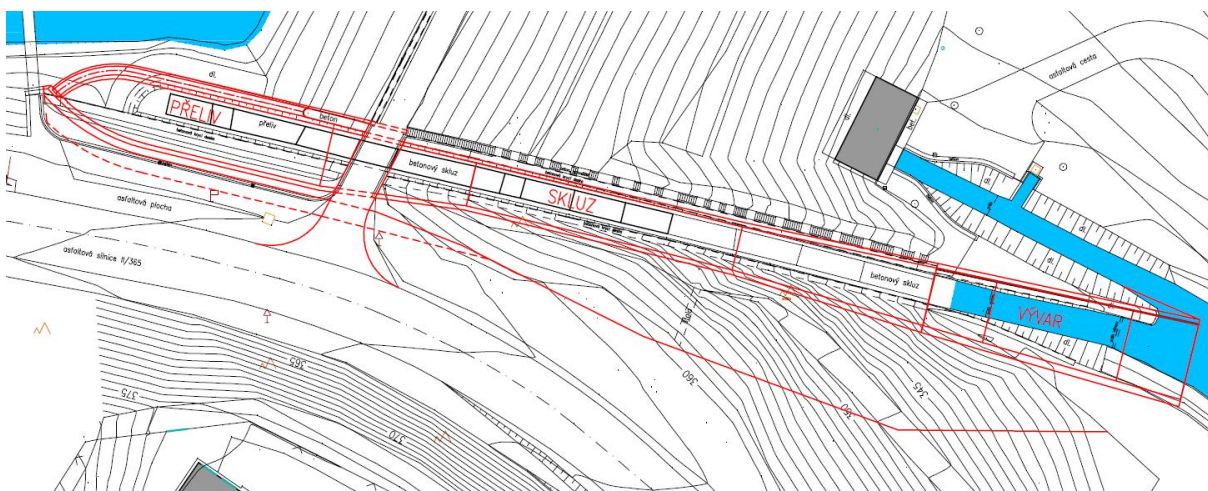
Skluz – půdorys, varianta s šířkou 8,0 m
